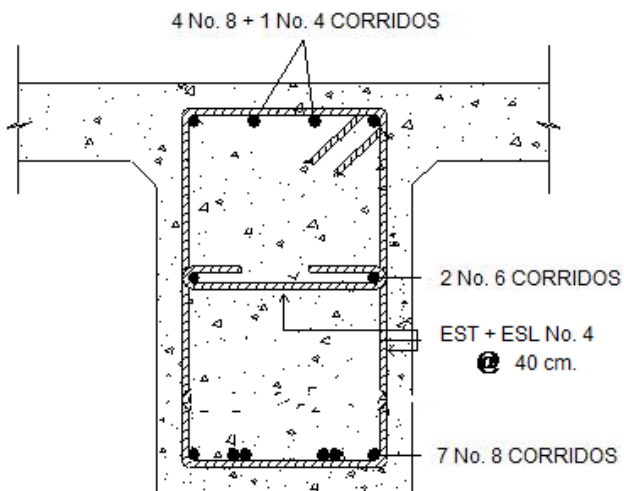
Detalle de armado de viga externa a 2.75 m del apoyo
